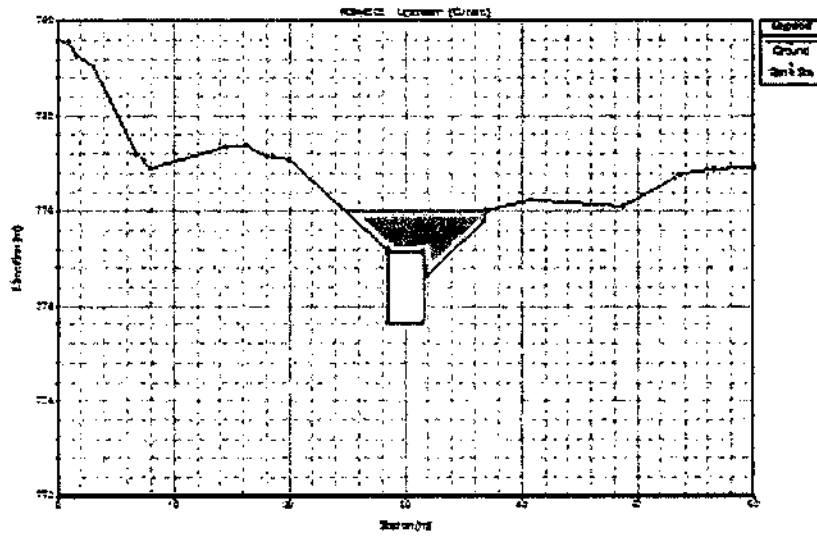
Entrada do bueiro de travessia da Rua Monte Alverne
